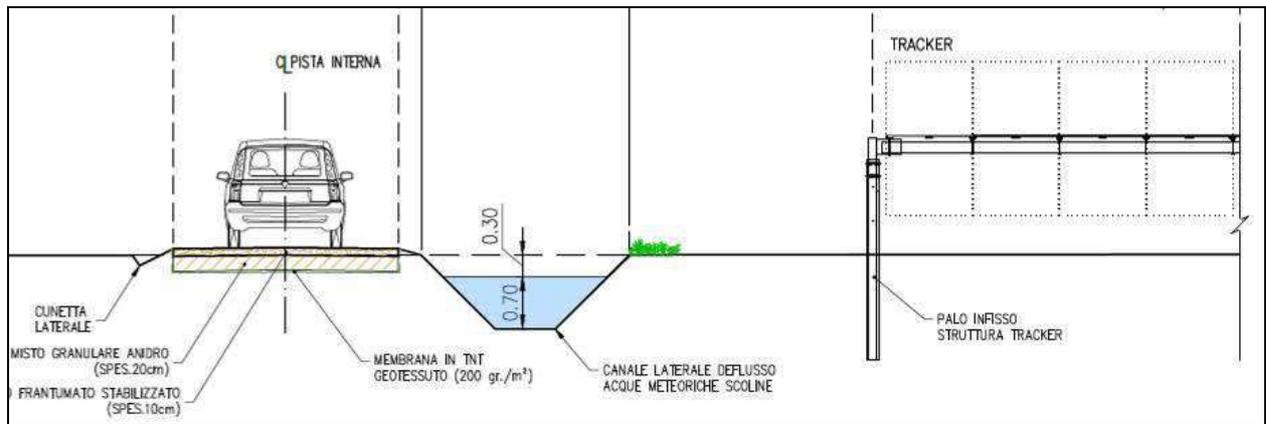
Sezione tipo della pista interna di gestione dell'impianto
